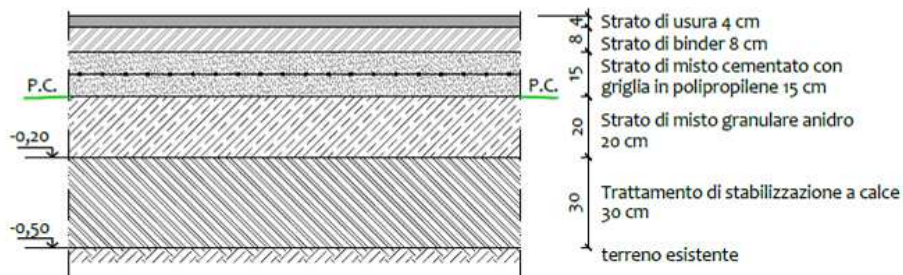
Sezione tipologica 1 e pacchetto di pavimentazione della pista di cantiere
